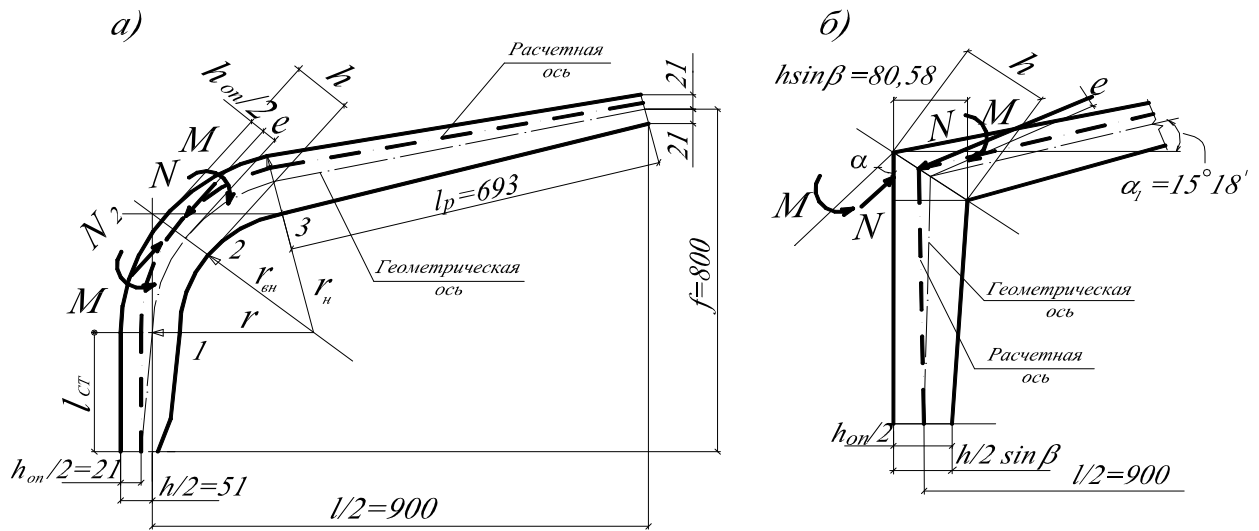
Схемы к определению усилий в карнизных узлах рам:
